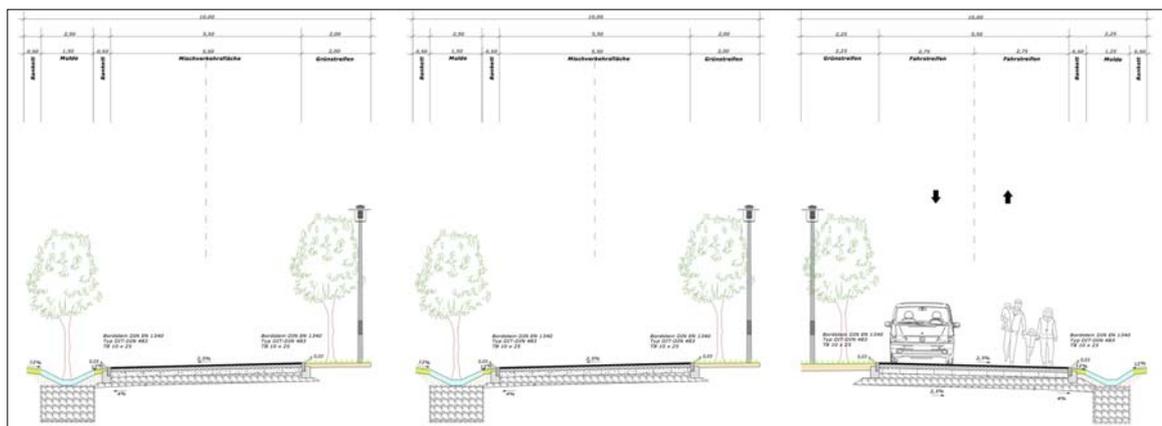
Prinzipquerschnitte der Planstraße A und C (links), D (mitte) und E (rechts)
